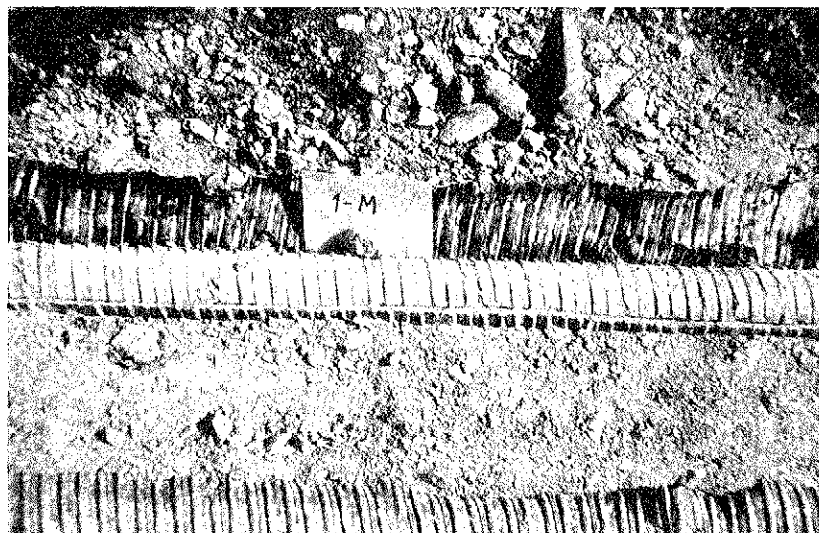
Estado de la inyección del tendón n° 1 lado Mar.
